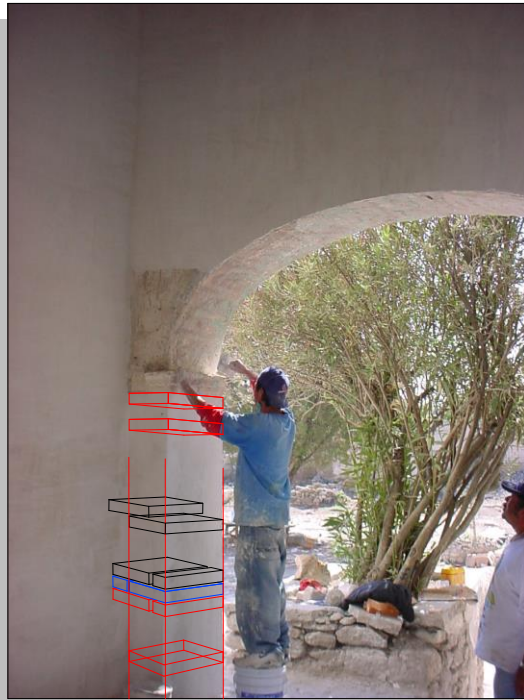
Detalle de una de las pilastras que dan acceso al patio principal, en donde se puede apreciar la reconstrucción hipotética de sus sistema constructivo, en una sección de 0.60 x 0.30 m.
